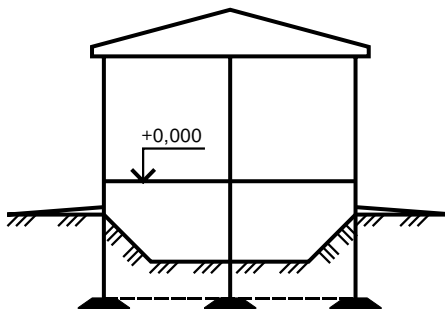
Сейсмостойкое здание с неотпливаемым подпольем при строительстве в вечномёрзлых грунтах
